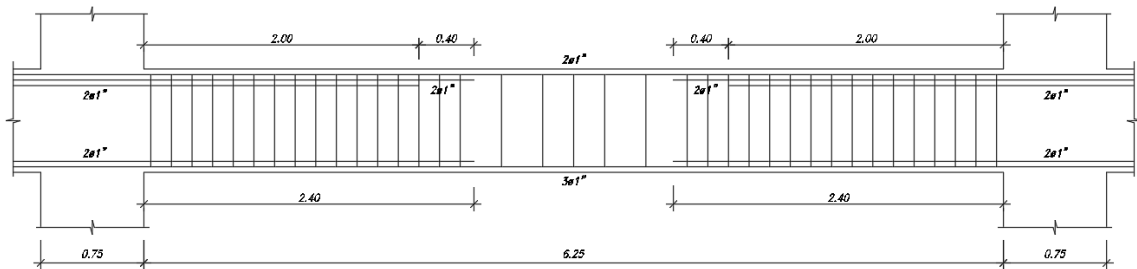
Distribución de acero en el tramo central de la viga VT-04
